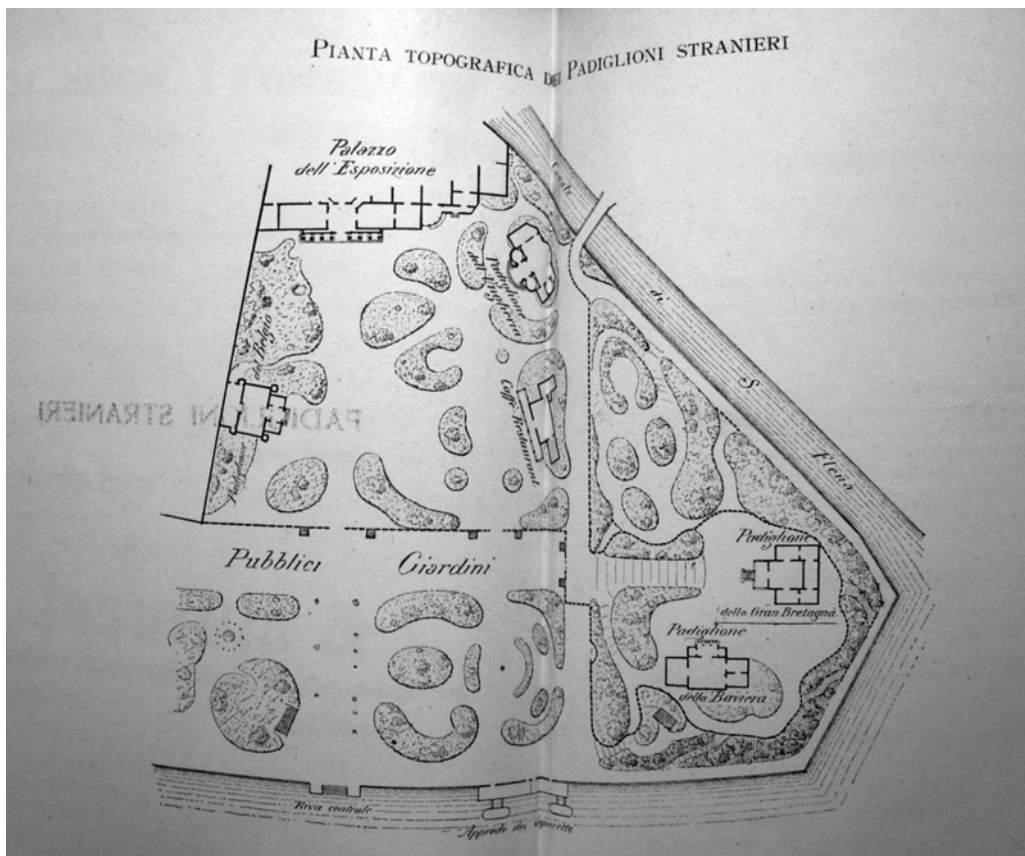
Planimetria dell'area della Biennale nel 1909.
